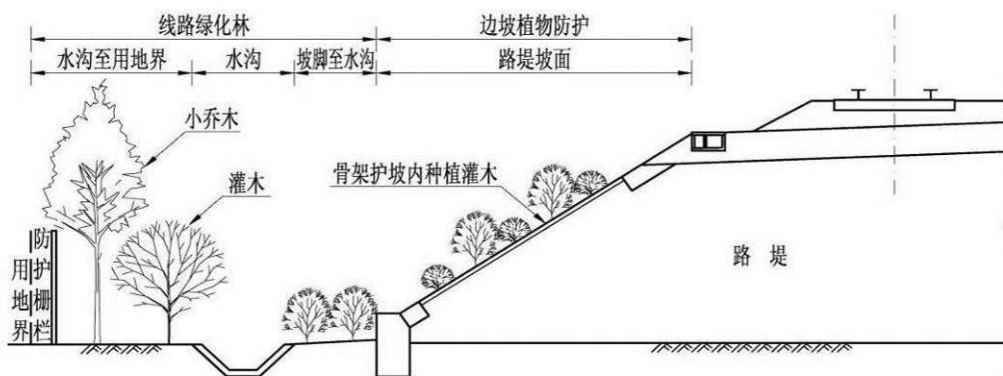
路堤地段绿化断面示意图 (边坡高度 3m~6m)
